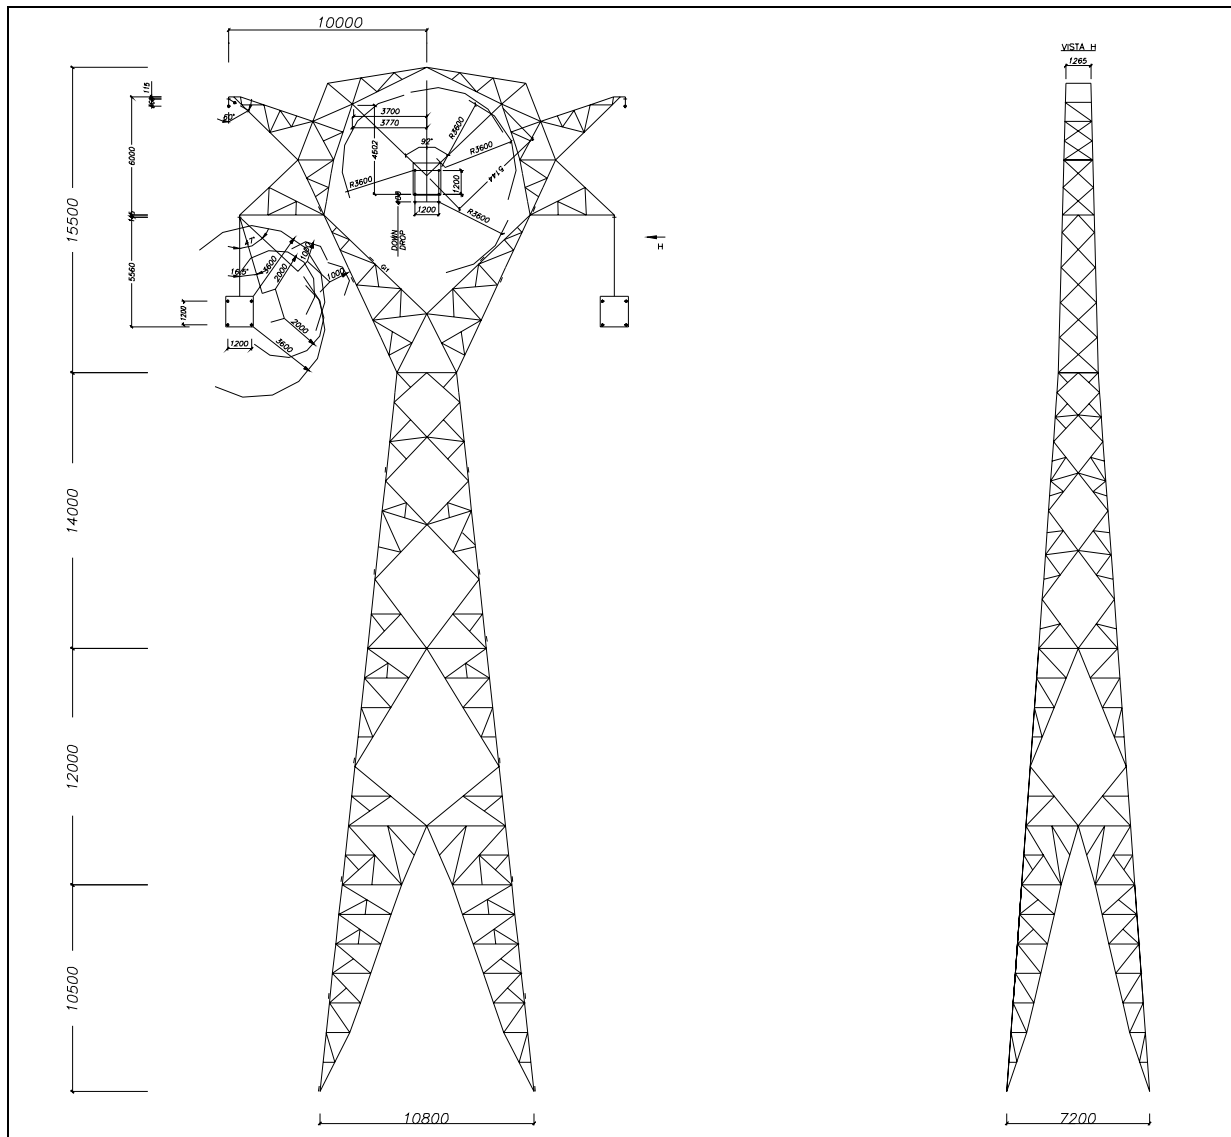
SILHUETA DA ESTRUTURA A55
